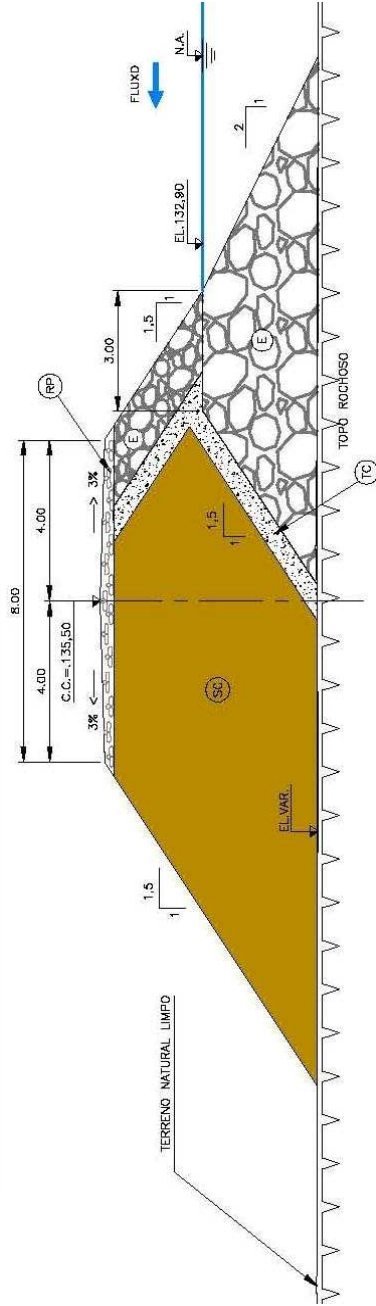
Ensecadeira de jusante 2ª Fase - seção tipo 3 – aterro dentro do arroio (trecho 2)
